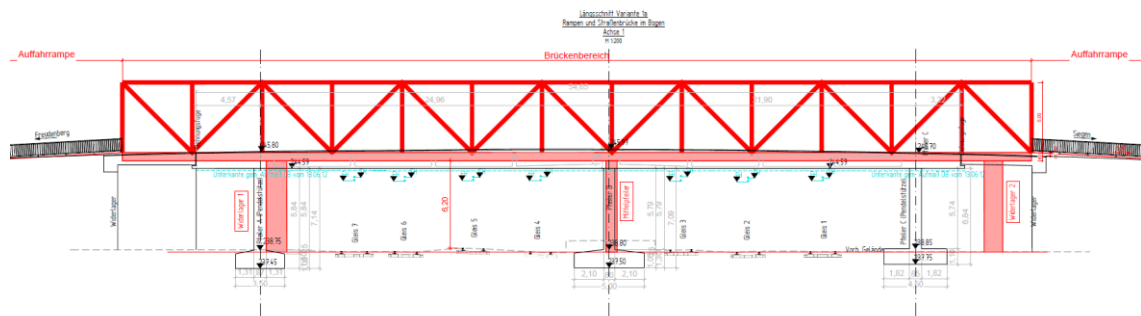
Schnitt Straßenbrücke Stahlfachwerk im Bogen, lichte Höhe 6,20m
